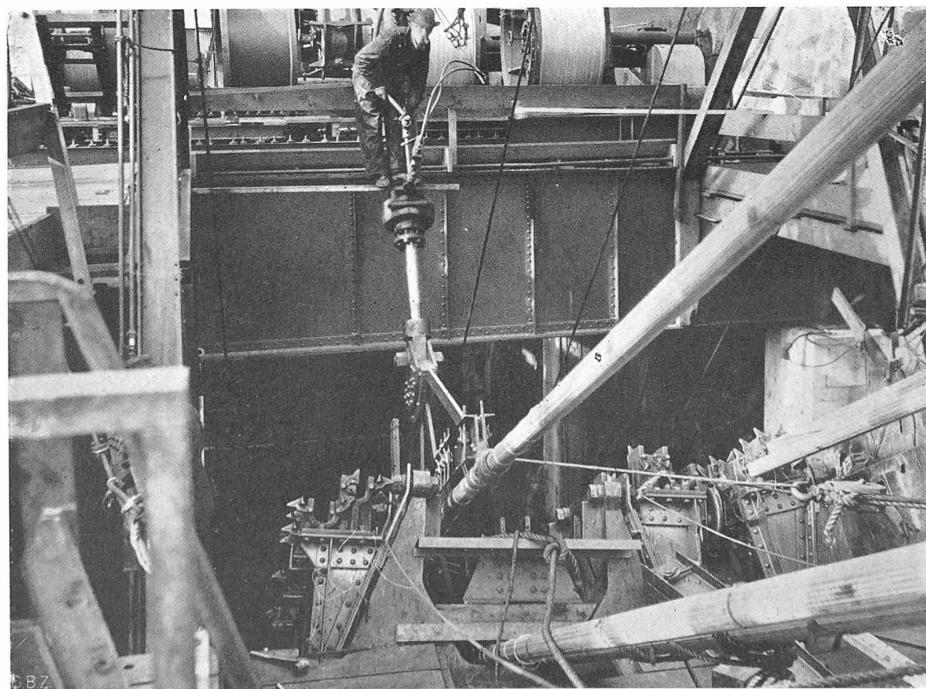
EINLEGEN EINES FERTIGEN DRAHTSTRANGES IN SEINE ENDGÜLTIGE LAGE
